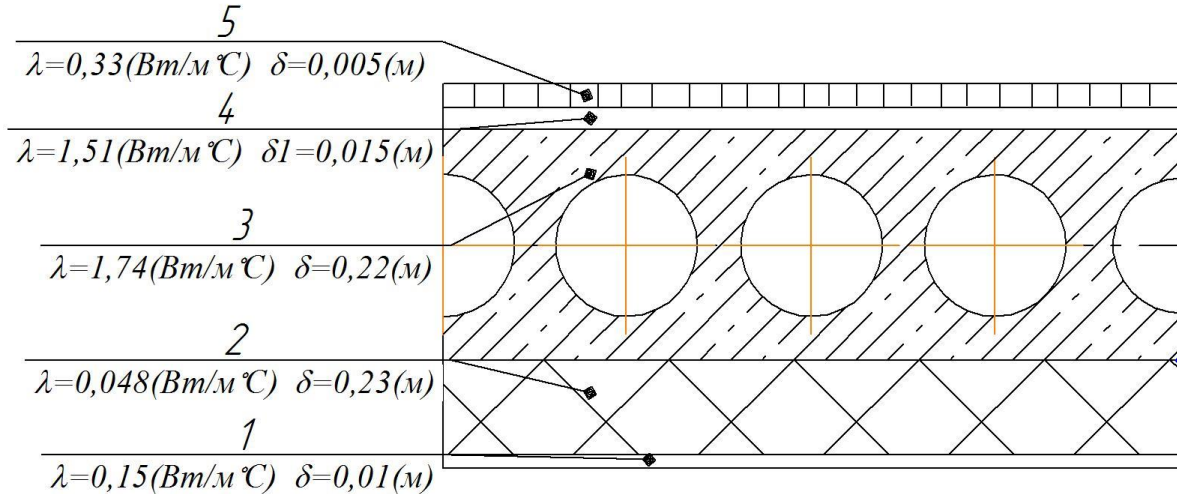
Схема утеплення перекриття: 1 - лист гіпсокартону, 2 - пластини мінеральної вати, 3 - залізобетонна плита, 4-бетонне покриття, 5–лінолеум.
